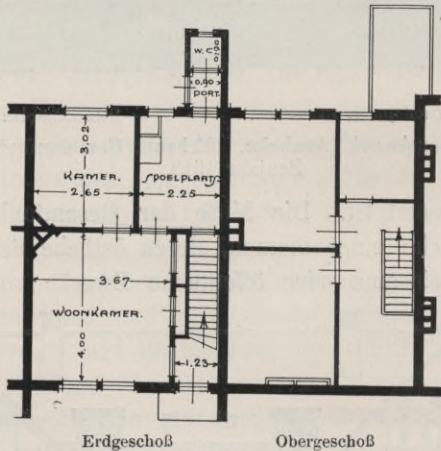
Einfamilienhaus der Anlage Abb. 69, Grundriß.
